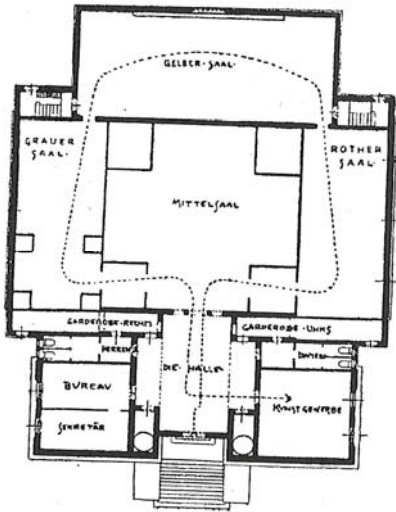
Grundriss, 4. Secessionsausstellung,
